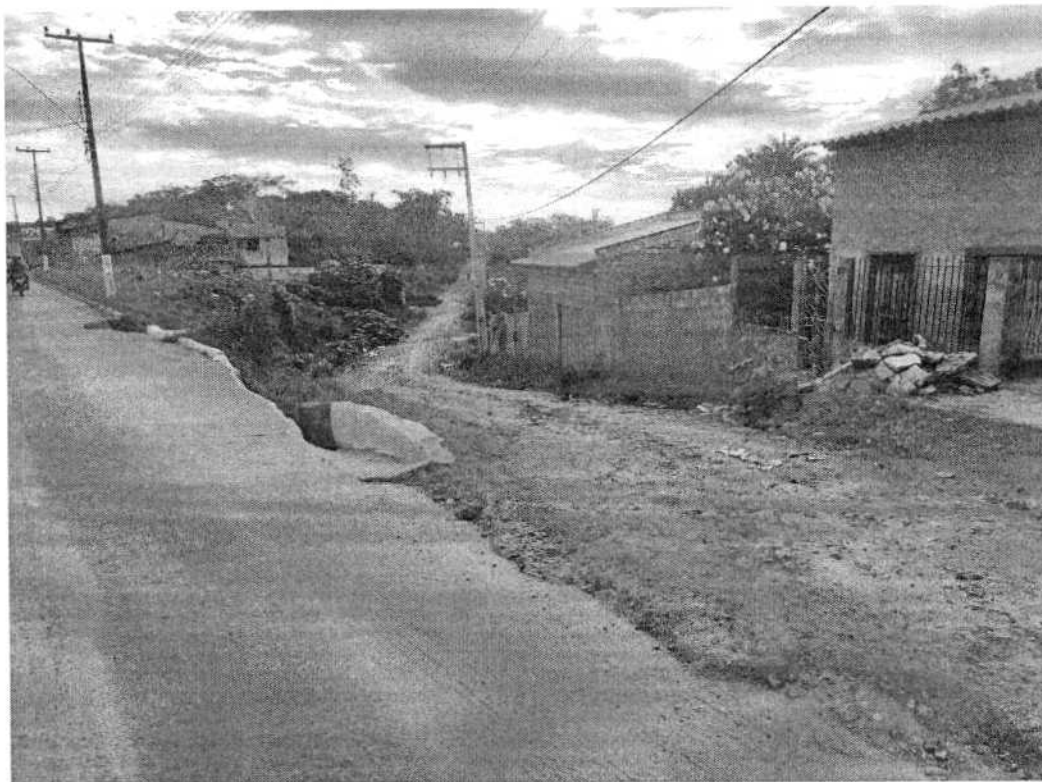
INICIO DA PAVIMENTAÇÃO
